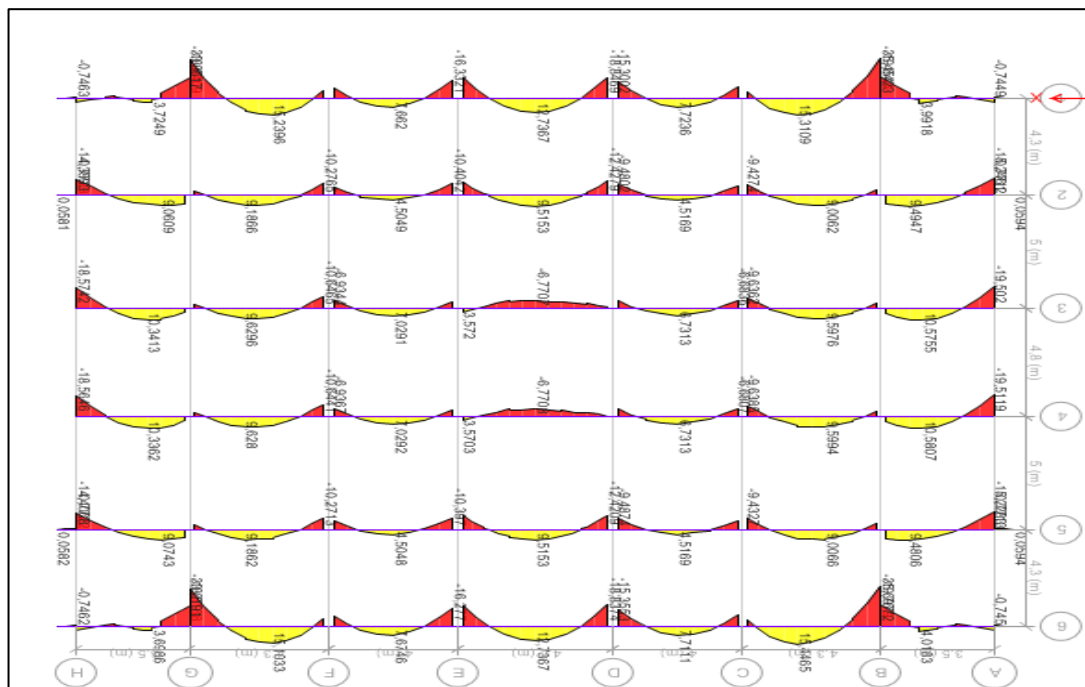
Moment fléchissant des poutres secondaires(ELS)
